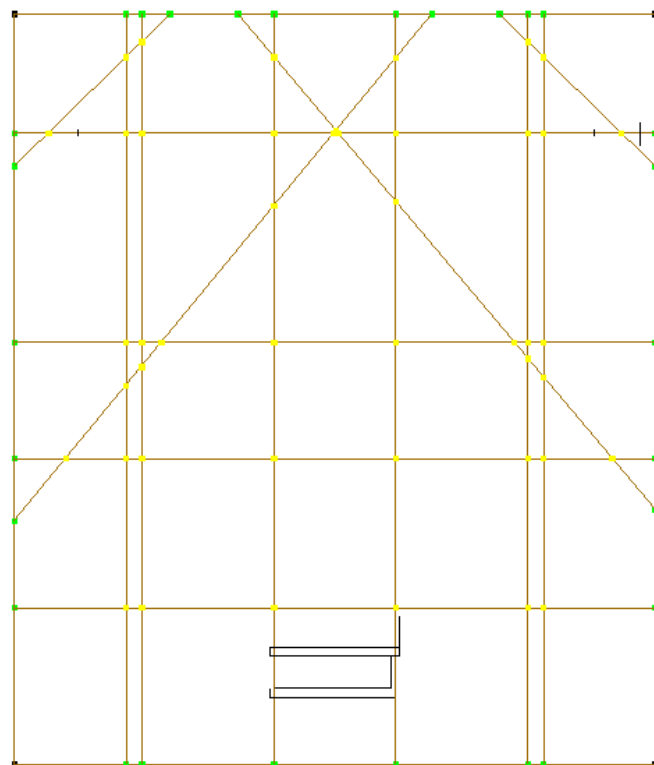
1 Esquema de distribución de paredes de la planta baja
